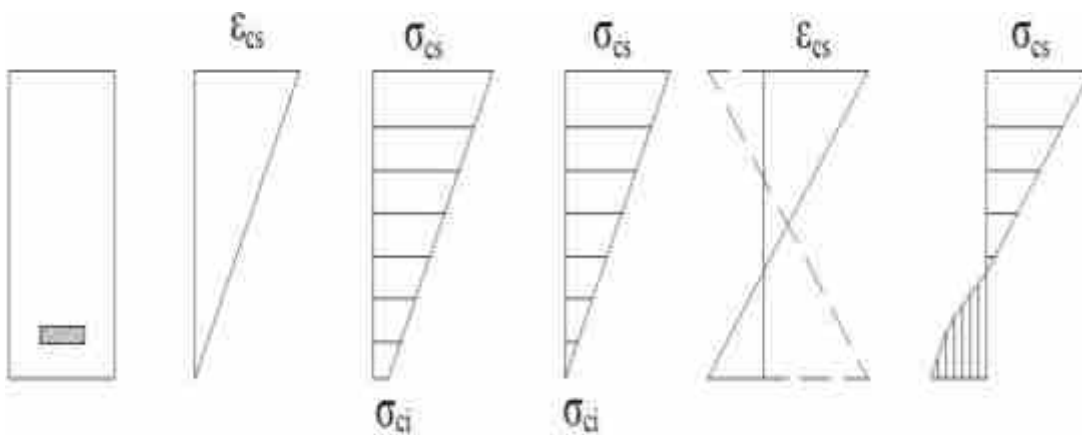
Keadaan Tegangan dan Regangan Beton, Dari Penampang Balok Di Bawah Beban Maksimum Untuk Struktur Kelas I
